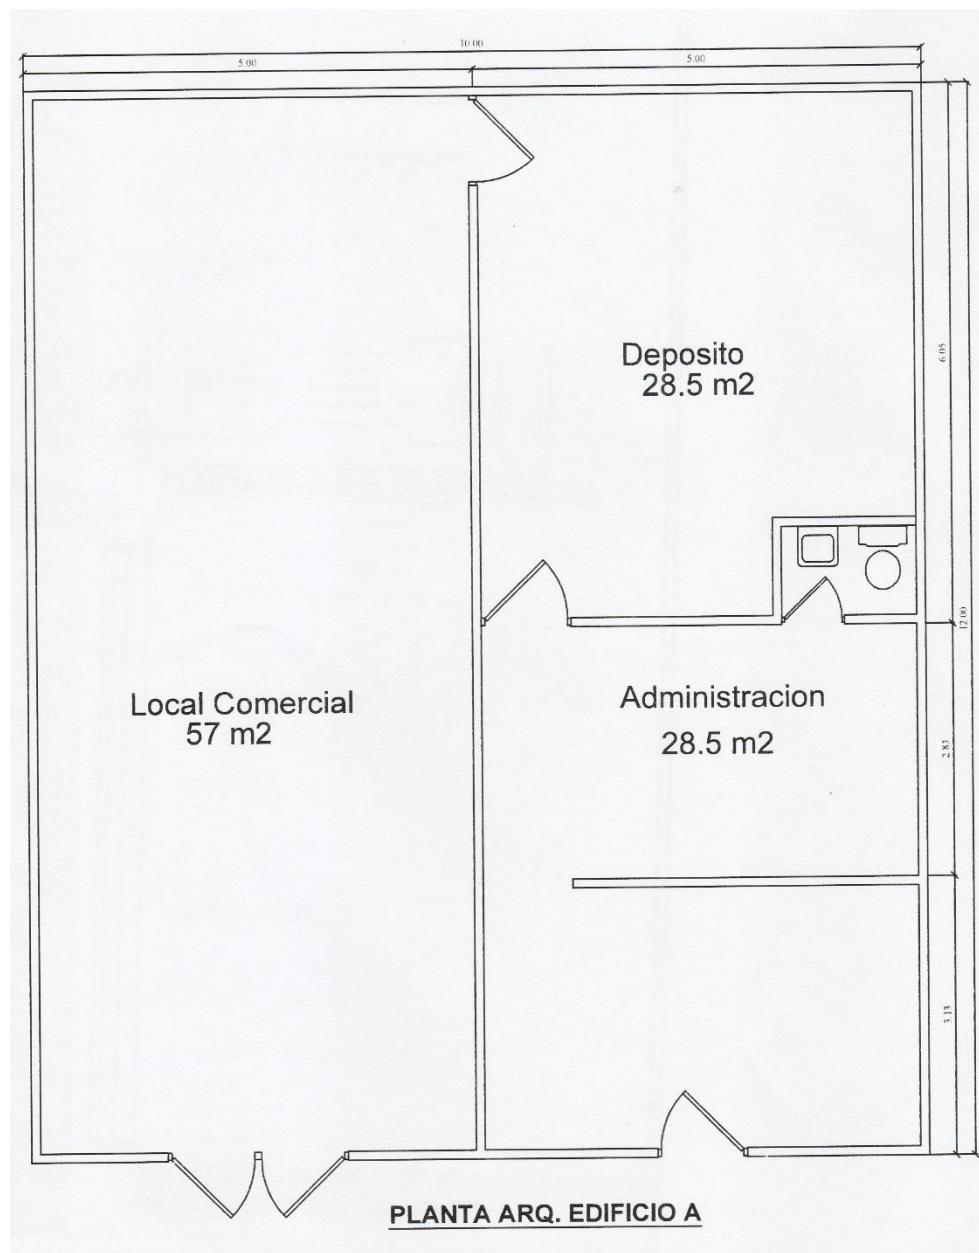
Planta Arq. Edificio A de Panta Baja.
